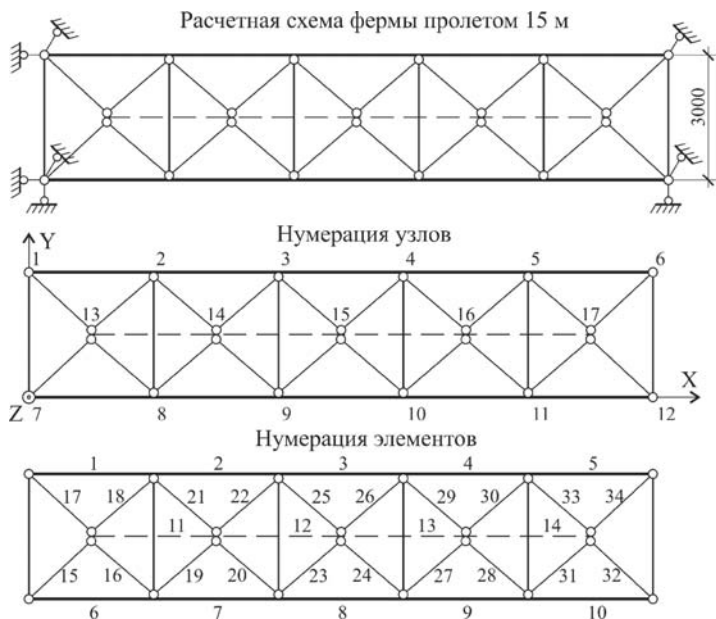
Расчетная схема ферм пролетом 15 м с центрированными узлами (вид в плане)
